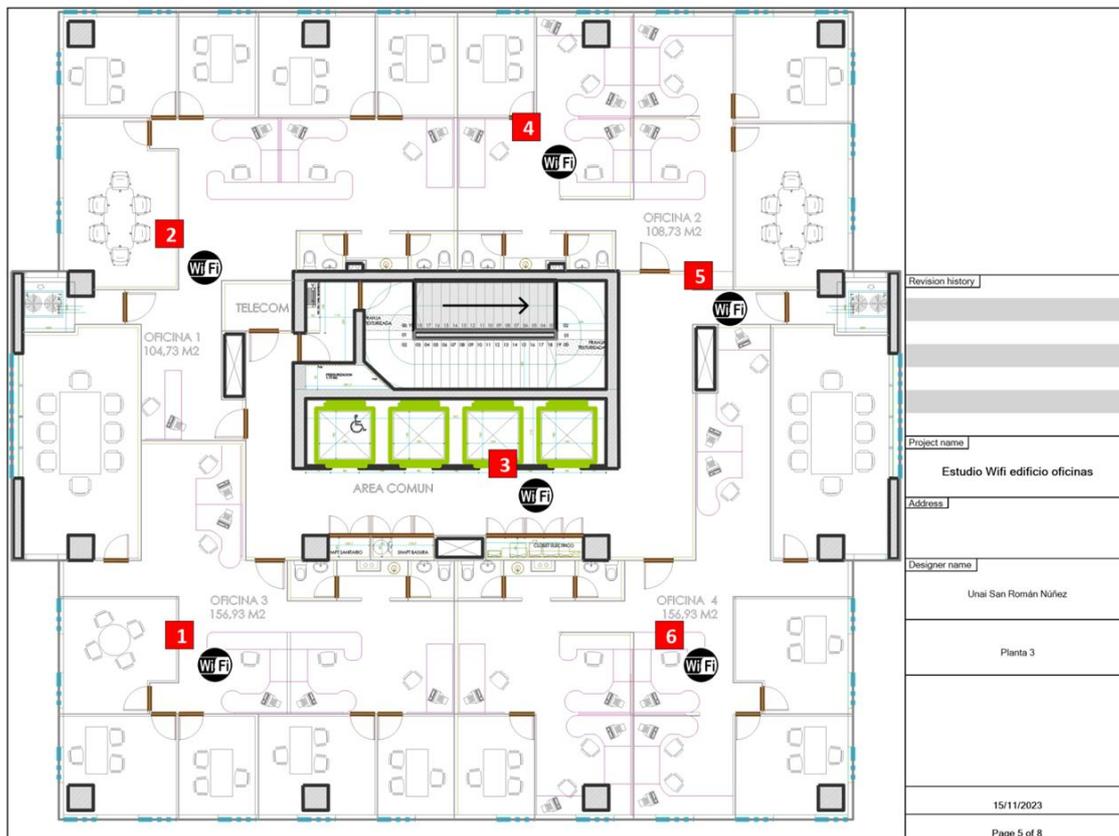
Posicionamiento Puntos de Acceso. Planta 3.
